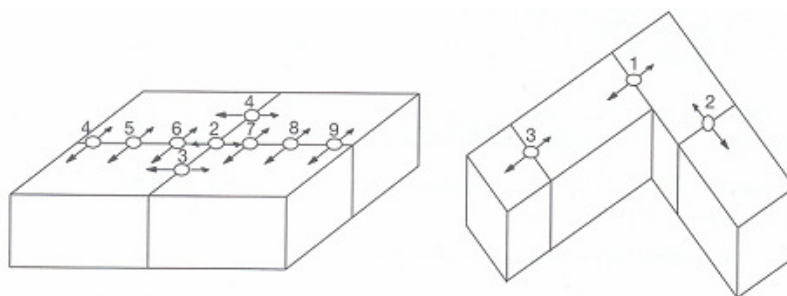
Aplicação/efeito em obra do cimento expansivo.
